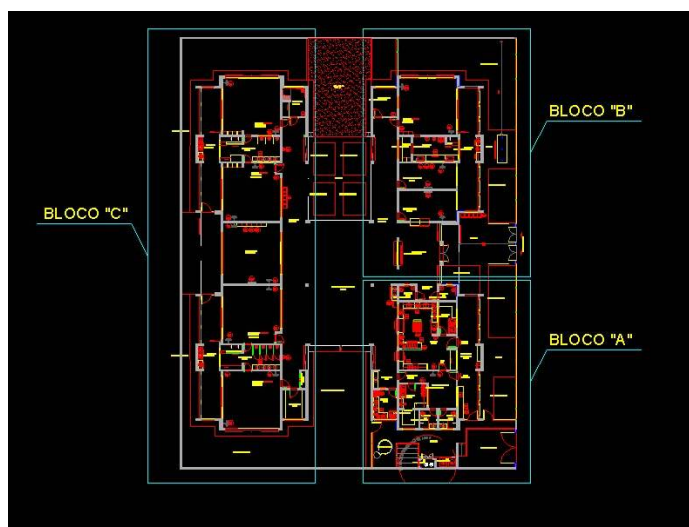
Demonstrativo da divisão da edificação em BLOCOS.
